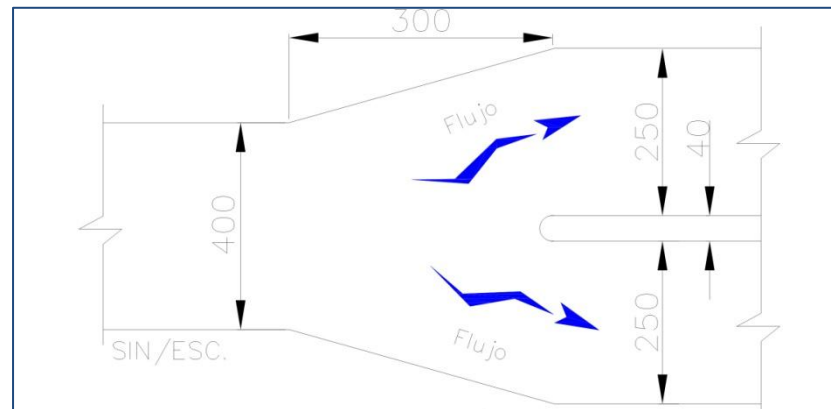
Detalle de transición horizontal 3. Cajón de 4.00 x 2.60 a doble cajón de 2.80 x 2.60.
